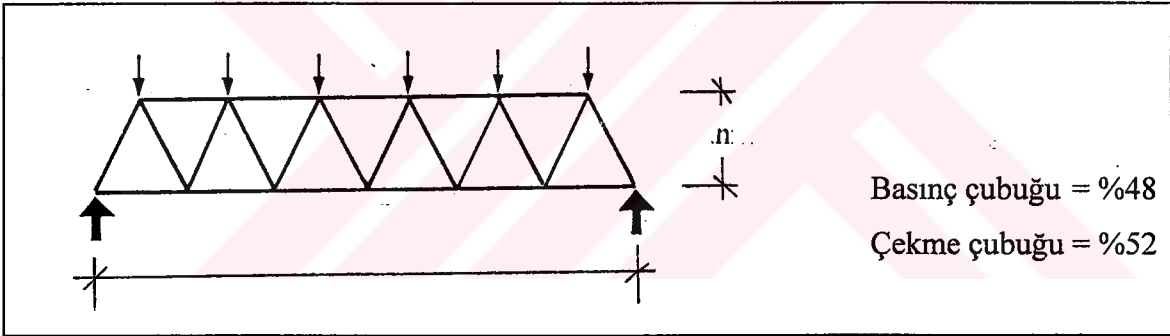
Paralel başlıklı kafes kiriş
